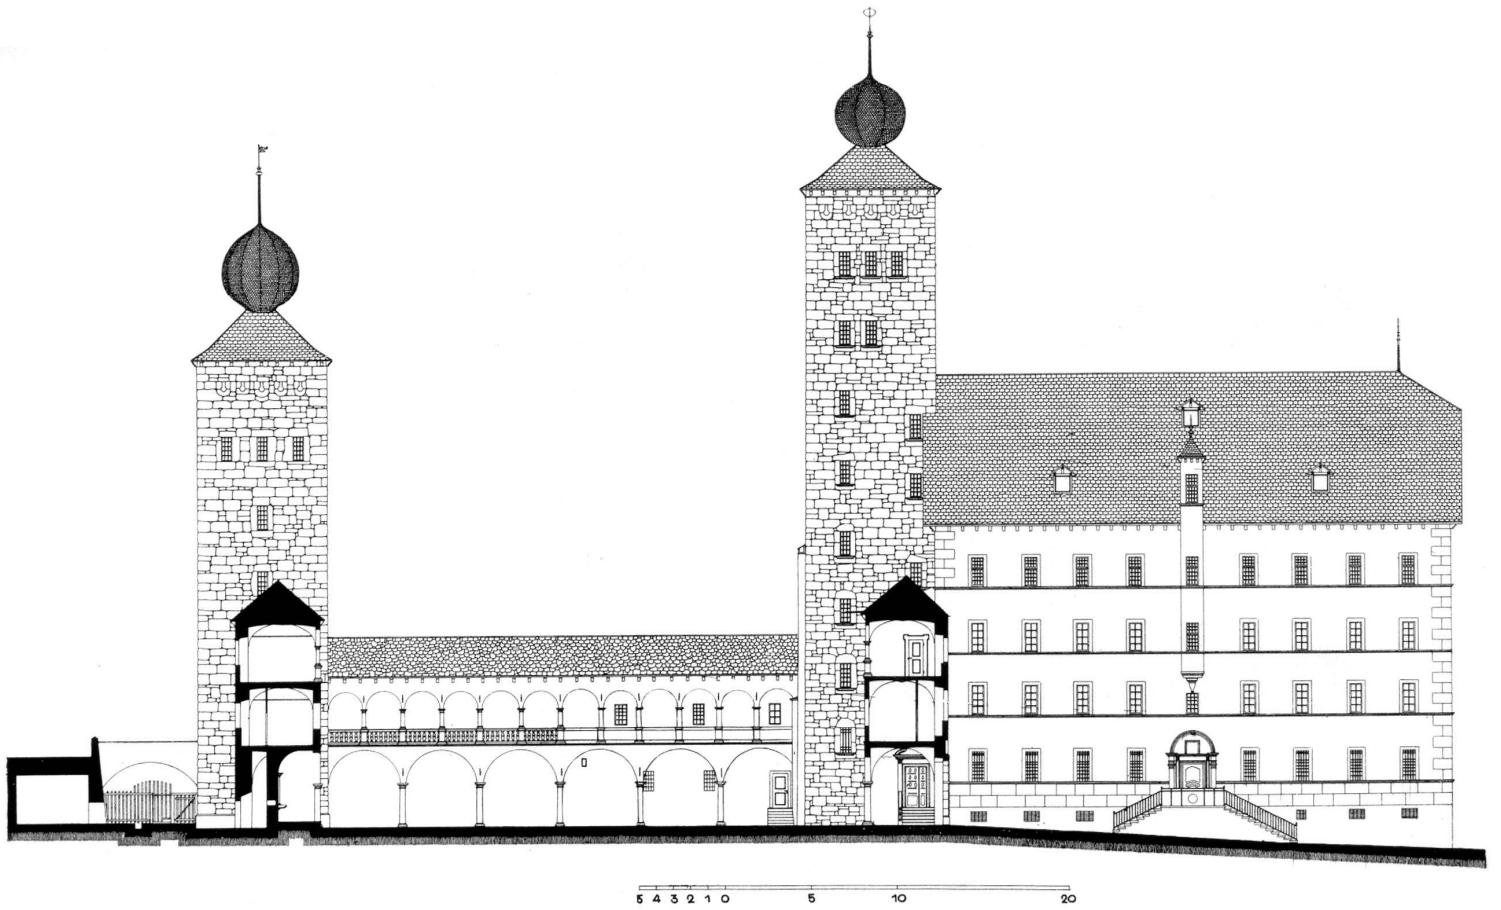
Brig, Schloß Stockalper, 1642/50, Ostfassade mit Hofansicht
